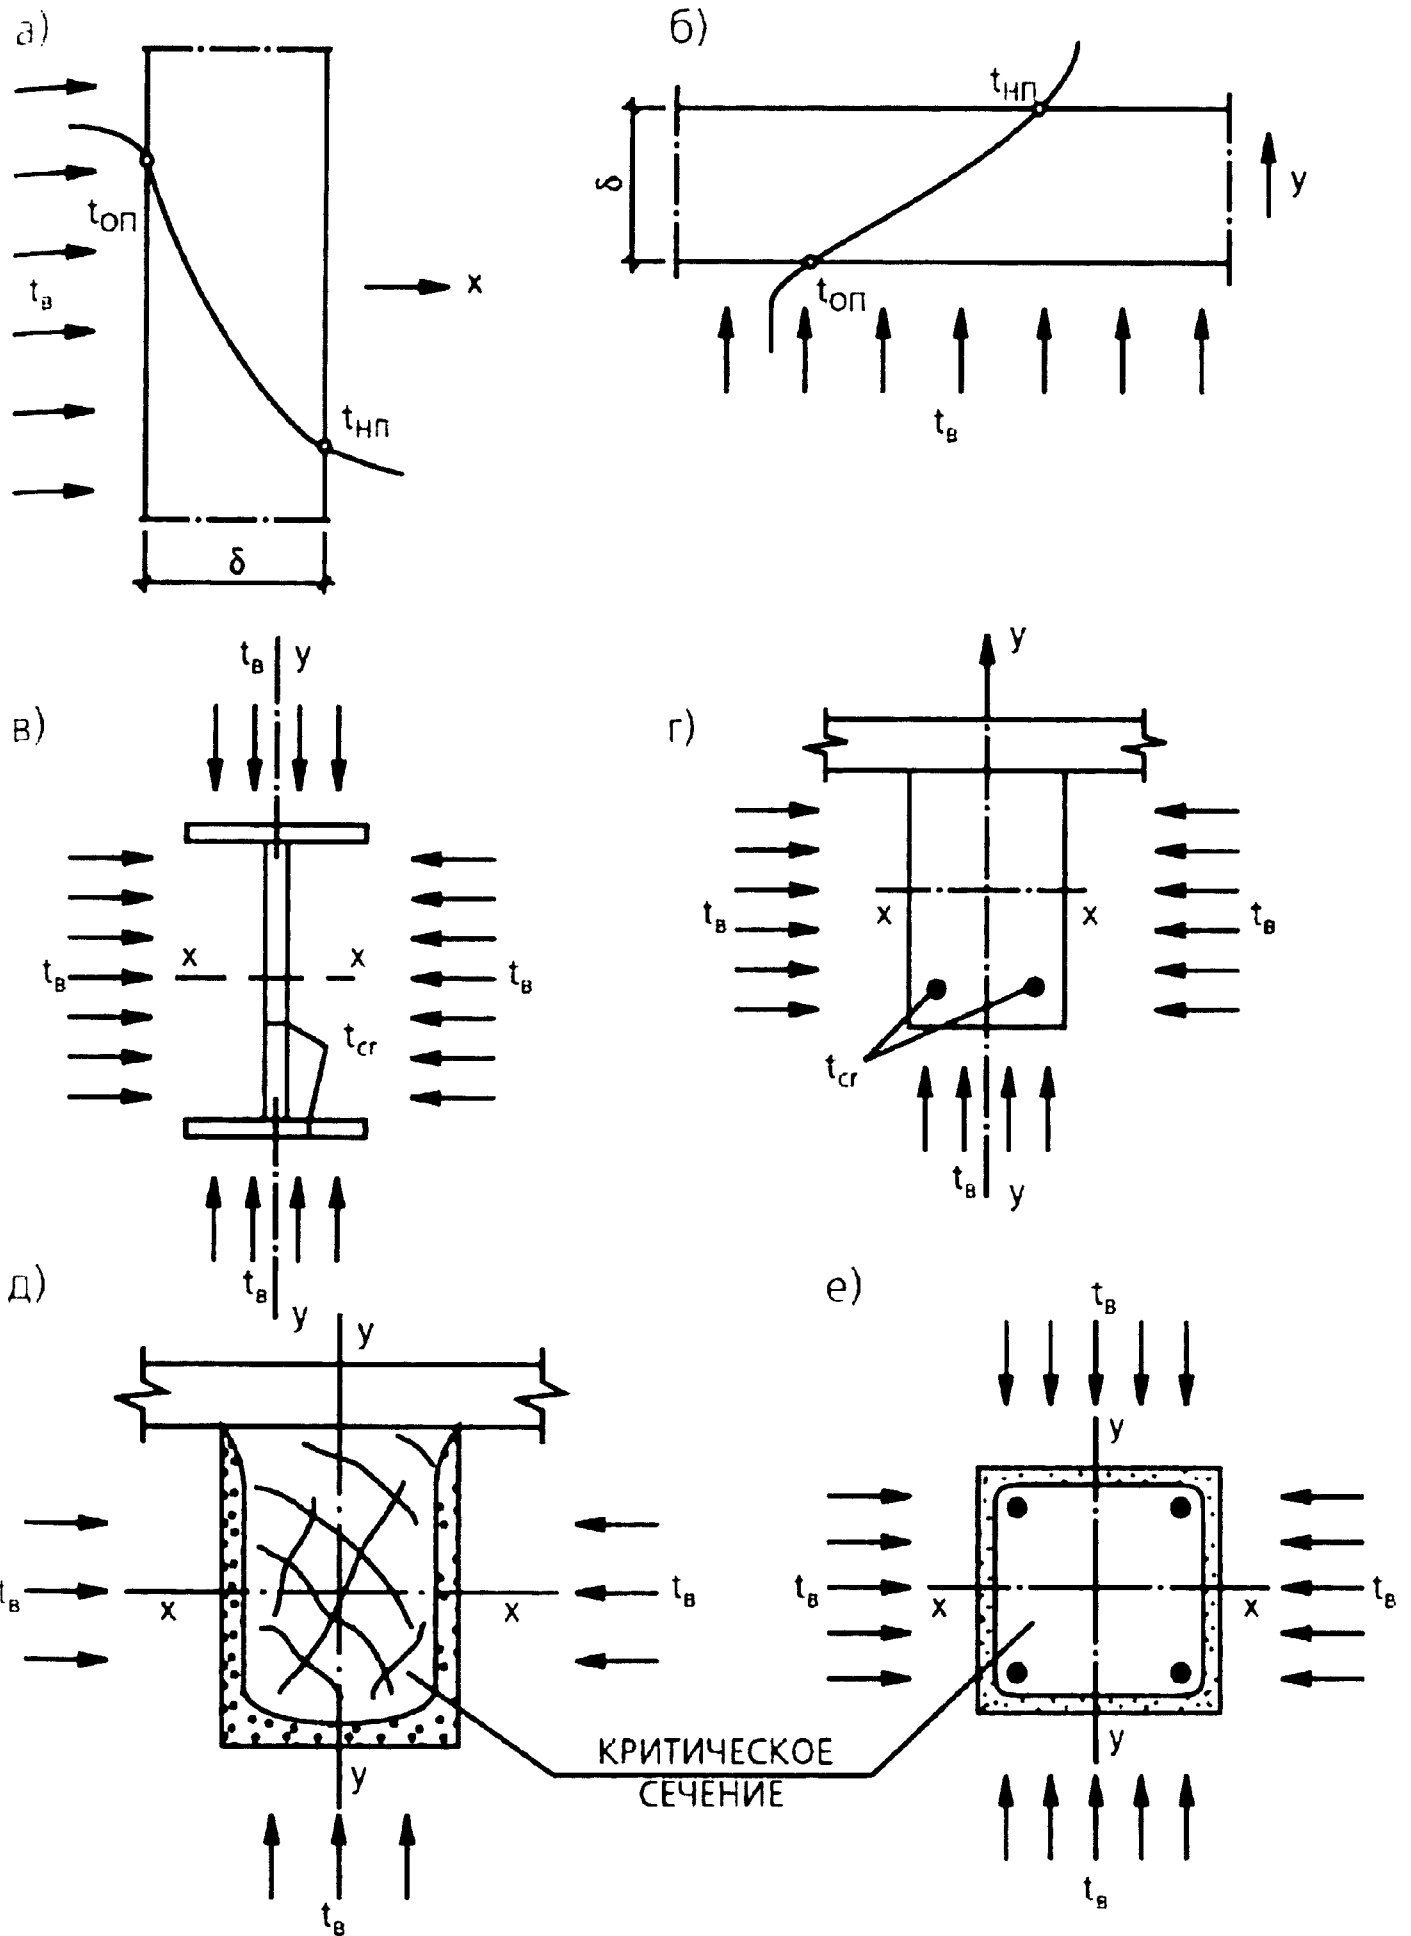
Расчетные схемы по определению фактического предела огнестойкости строительных конструкций: а, б - вертикальных и горизонтальных ограждающих конструкций (Расчетная схема 1); в, г - металлической и железобетонной балок (Расчетная схема 2); д, е - деревянной балки и железобетонной колонны (Расчетная схема 3)
